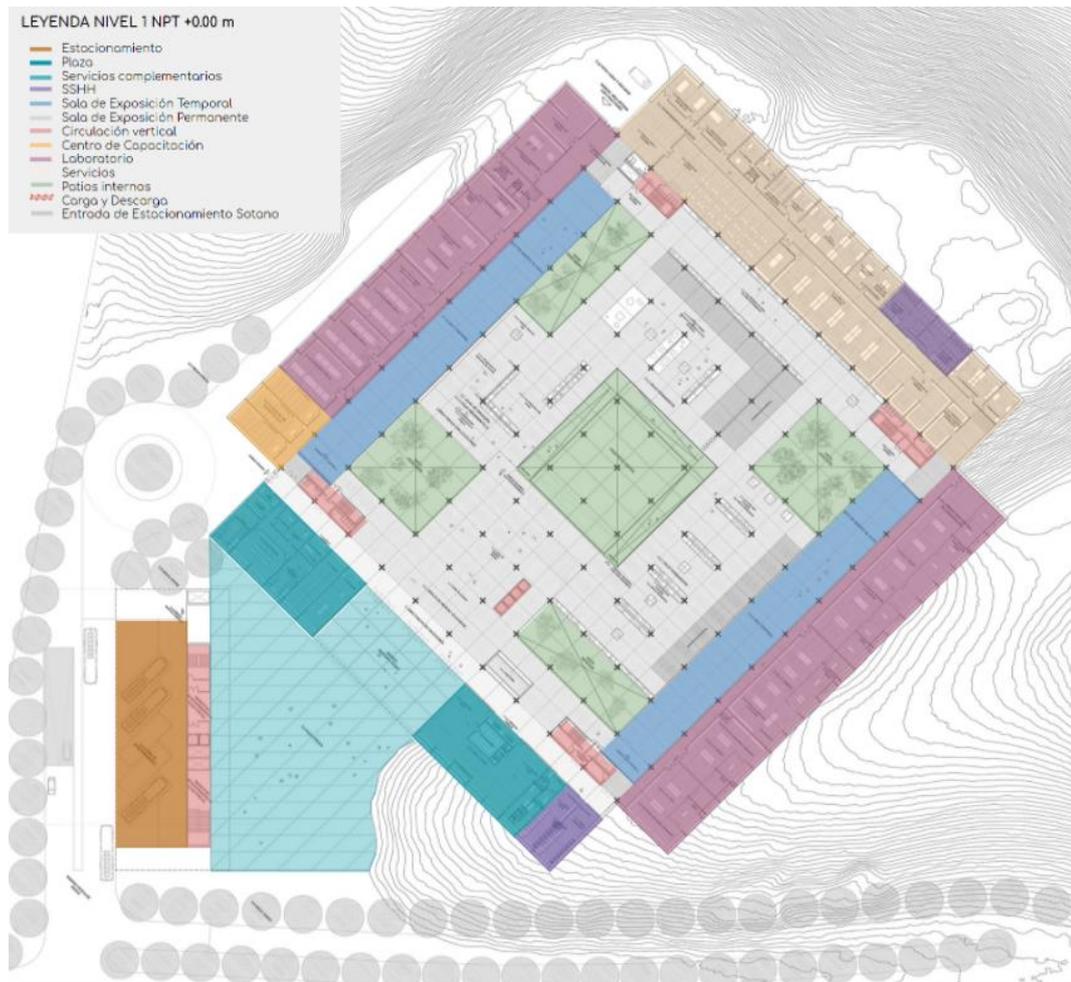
Planta de primer nivel. Fuente: Archdaily, 2014. Elaboración: Imagen de cortesía de Alexia León Angell adaptada por el equipo de tesis, 2014.
